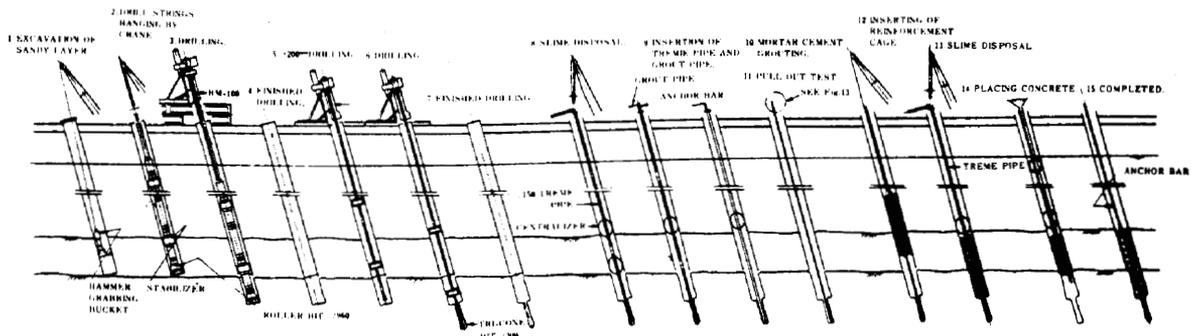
キーイングイン工法岩着杭の施工手順(斜杭)
